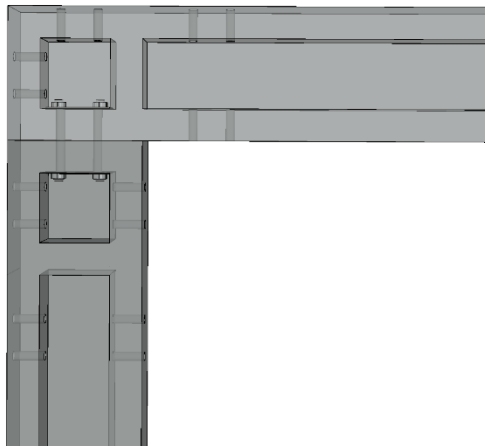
10 Sambungan Balok Kolom lantai 2 3D
